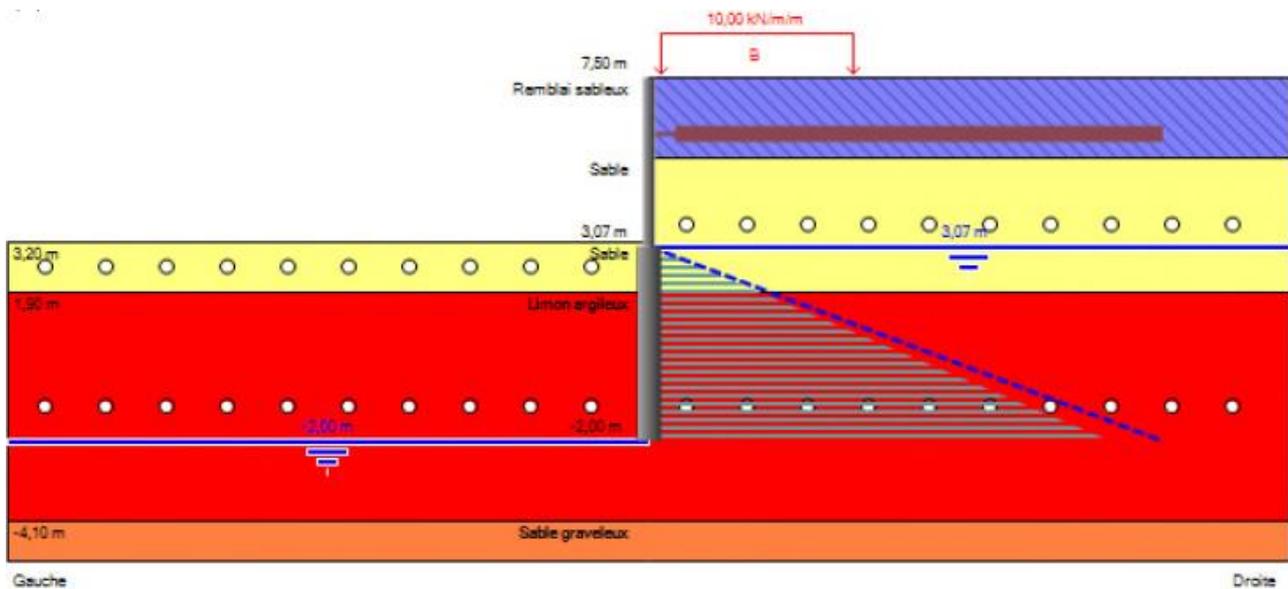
SCHEMA DE PRINCIPE DU CALCUL DE STABILITE – PALPLANCHES AVEC TIRANTS (GEOTEC, 2022)
